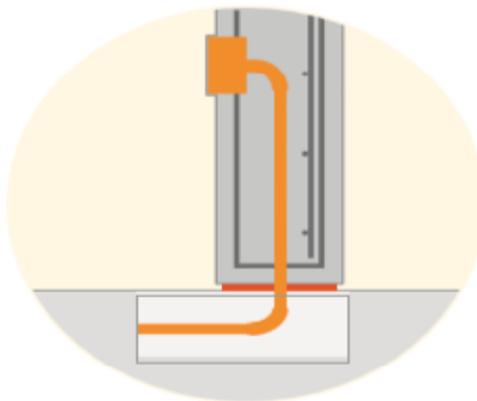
Instalaciones Eléctricas Fuente: Baumax
